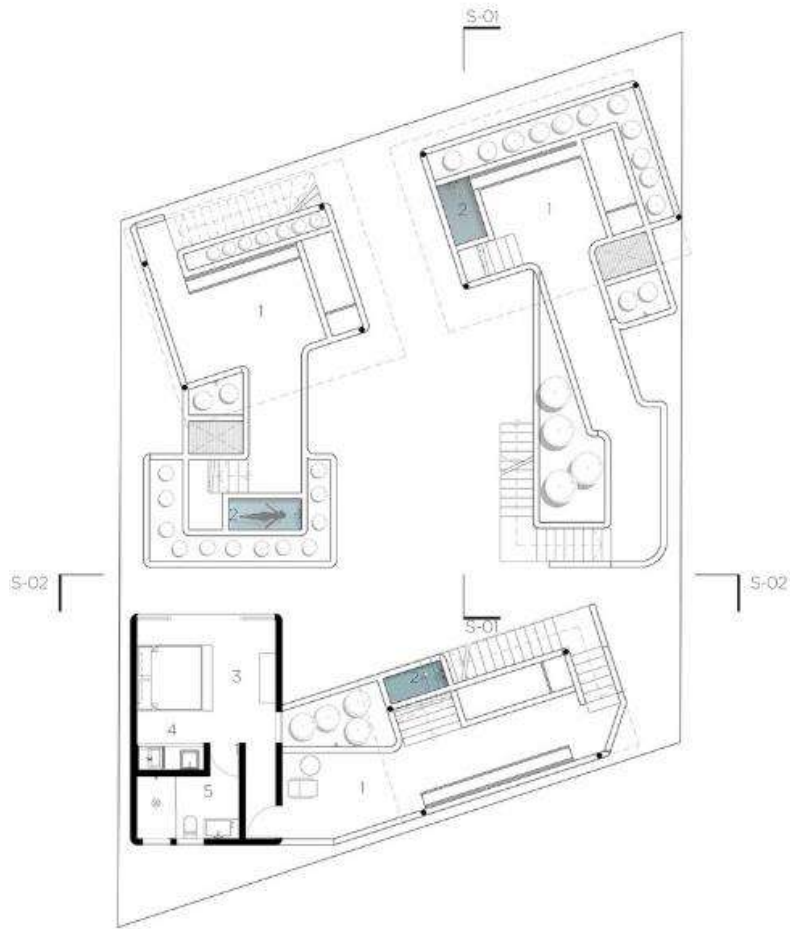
Planta de conjunto arquitectónica, Viviendas Apsara. Fuente: Beast Estudio Creativo
